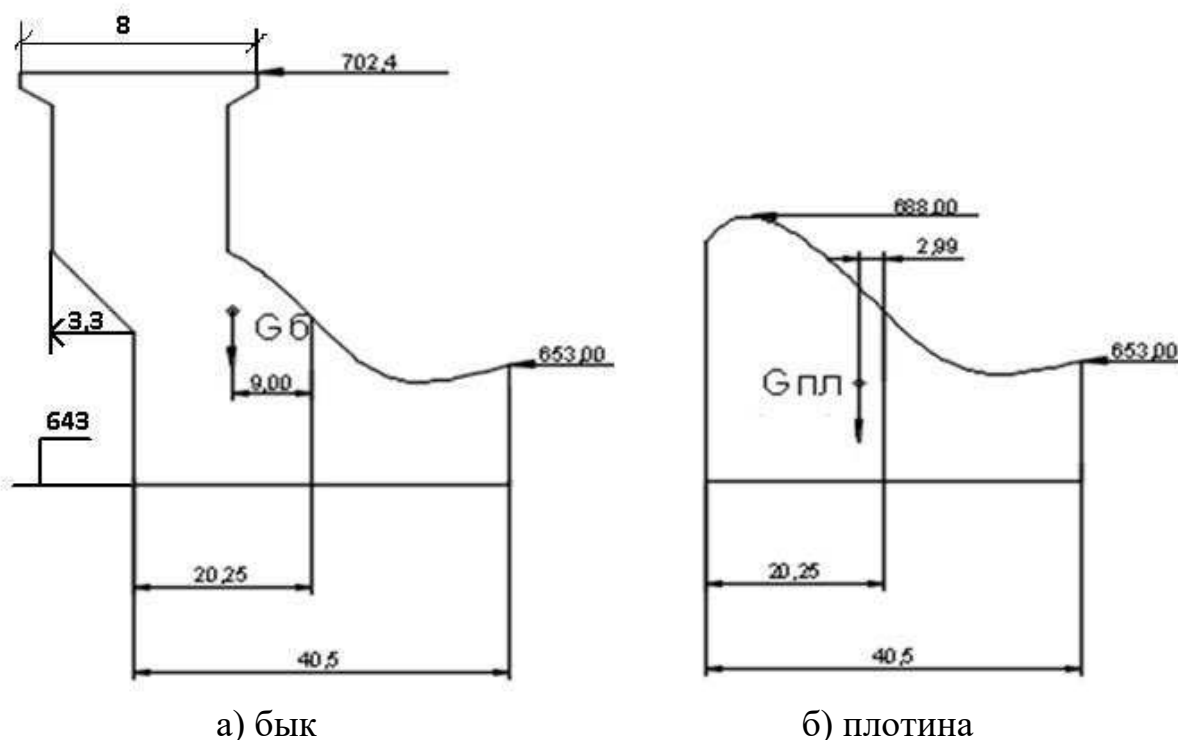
Поперечный разрез для определения площади поперечного сечения
